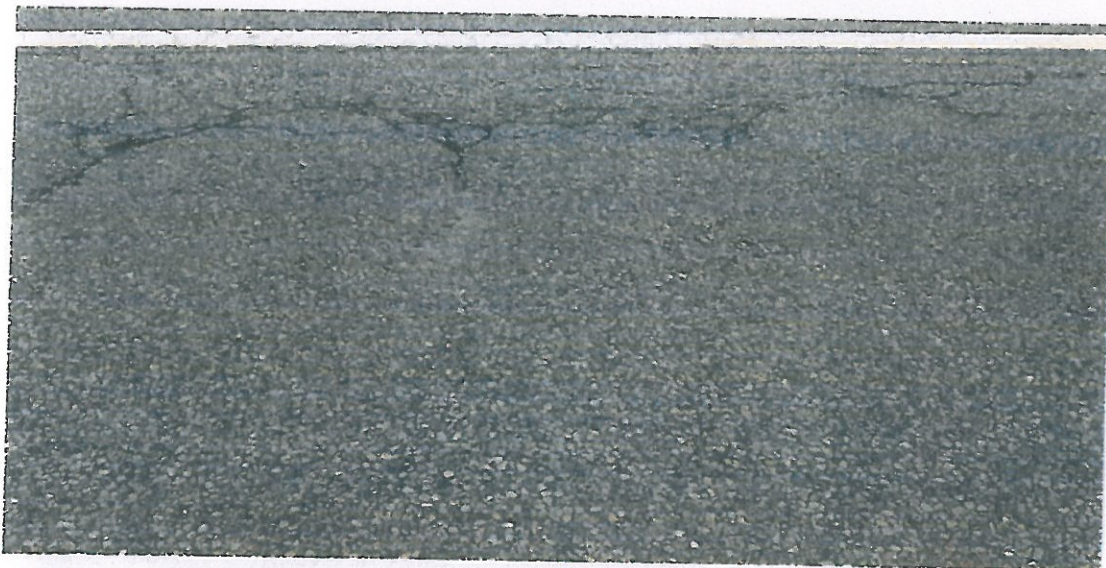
ca. km 42.10, fessurazione longitudinale a centro strada
